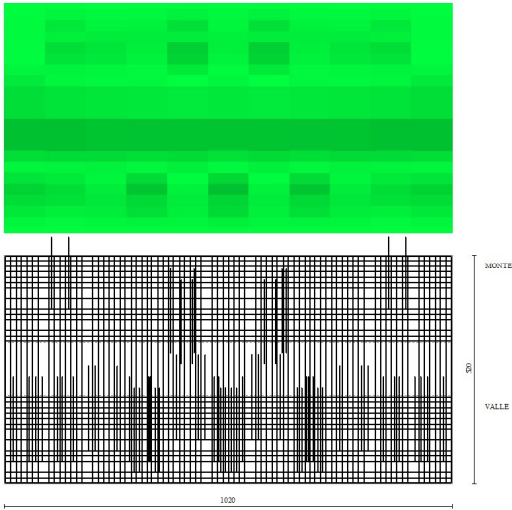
Piastra fondazione dir. Y (Inviluppo)
